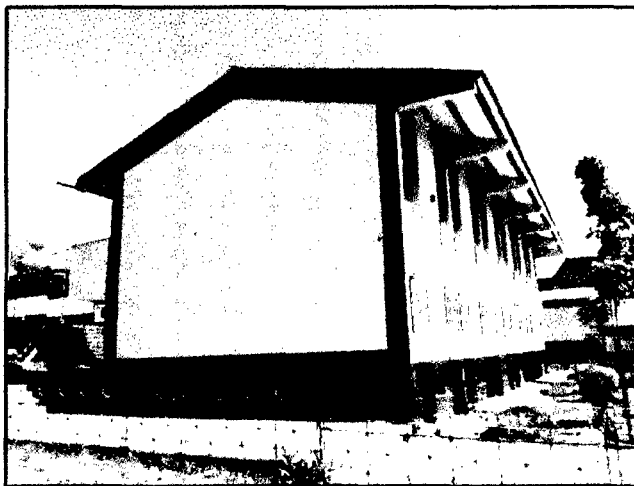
Pabellón 2. Edificio cimentado sobre terreno con pendiente plana.
